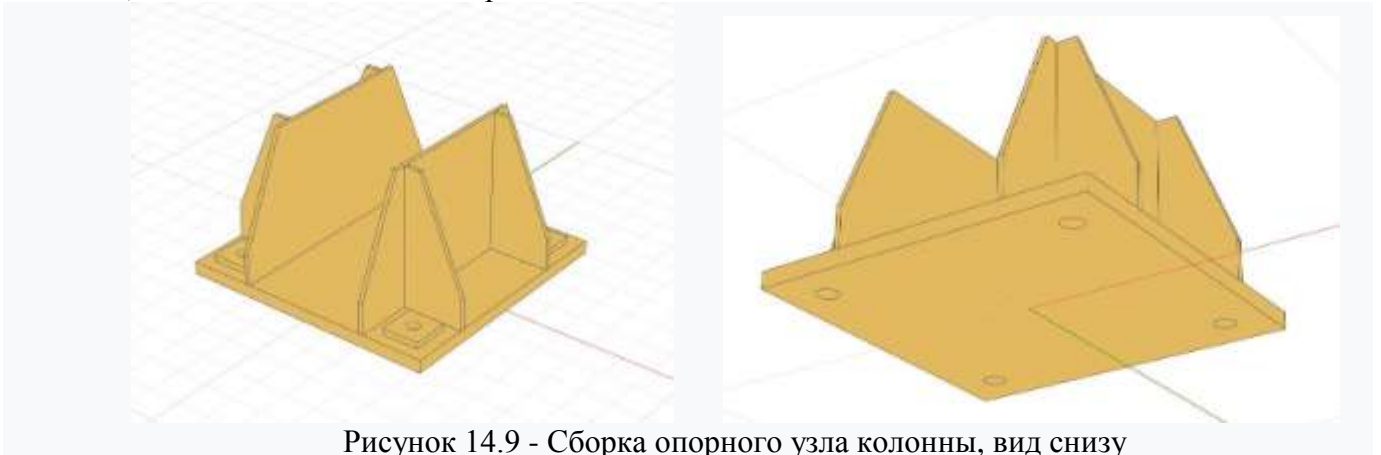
Сборка опорного узла колонны, вид снизу
